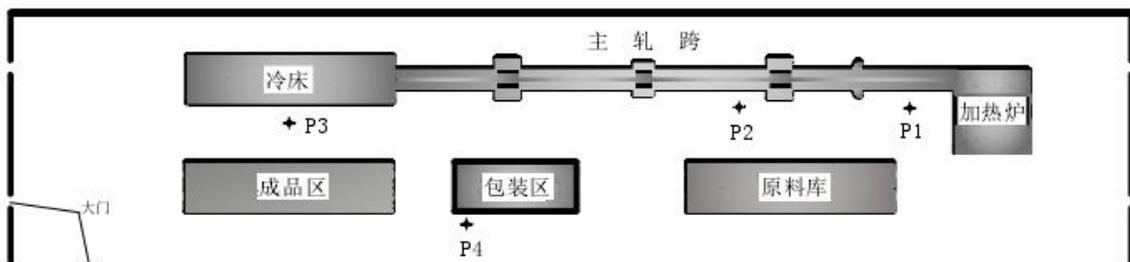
厂房热源布置及测点位置平面图 (P 表示测点)
